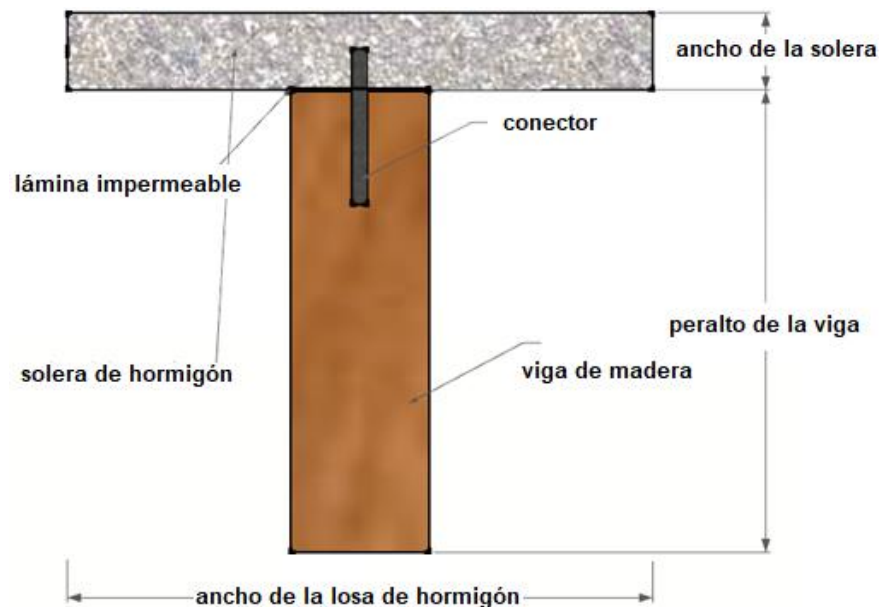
Sección de la viga de madera y la capa de hormigón para el diseño.
